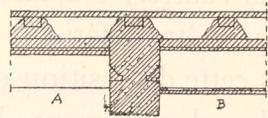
Plancher avec solives assemblées dans les poutres.
